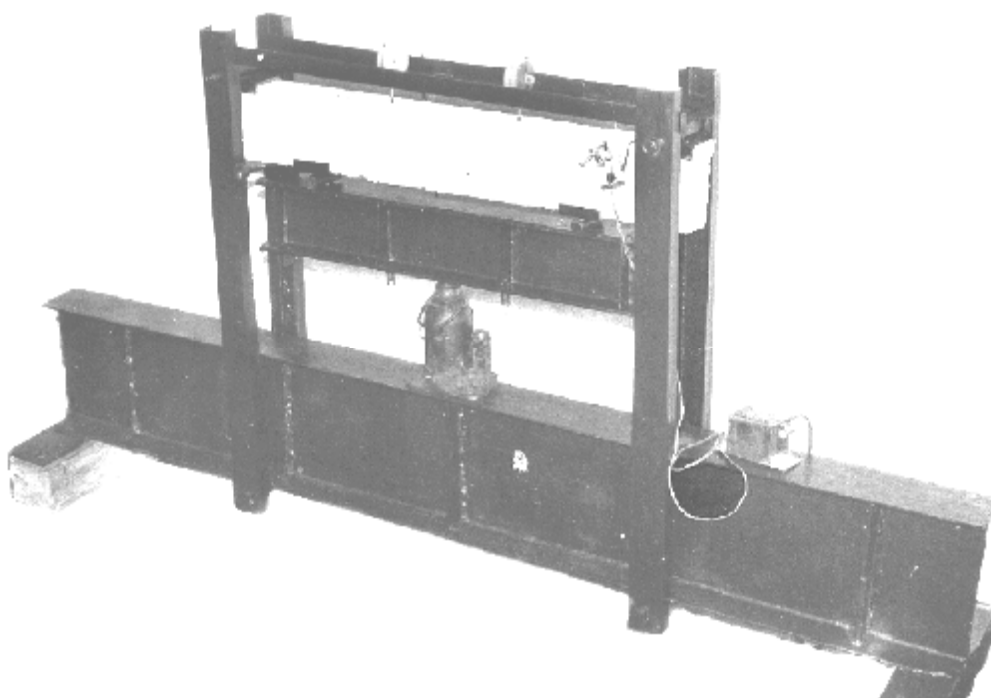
Общий вид экспериментального металлического стенда при испытании балки на изгиб с разрушением по наклонному сечению.
